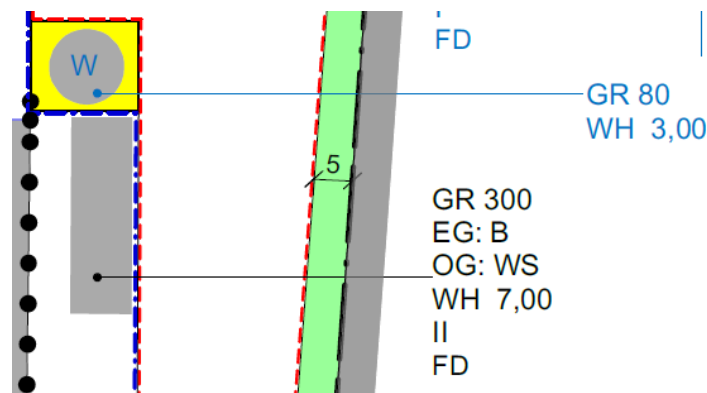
Teilbereich Versorgungsfläche mit Wassertank, Ausschnitt Bebauungsplan, o. Maßstab
